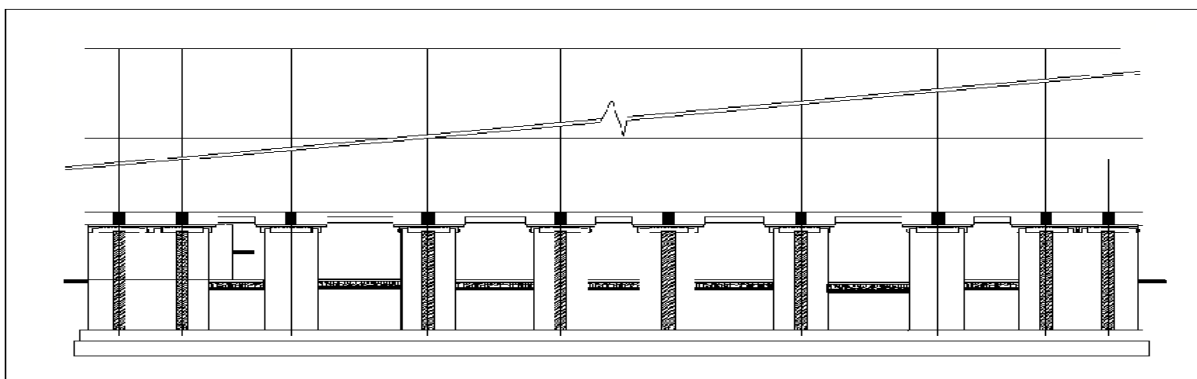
Coupe longitudinale au niveau des socles de fondation
